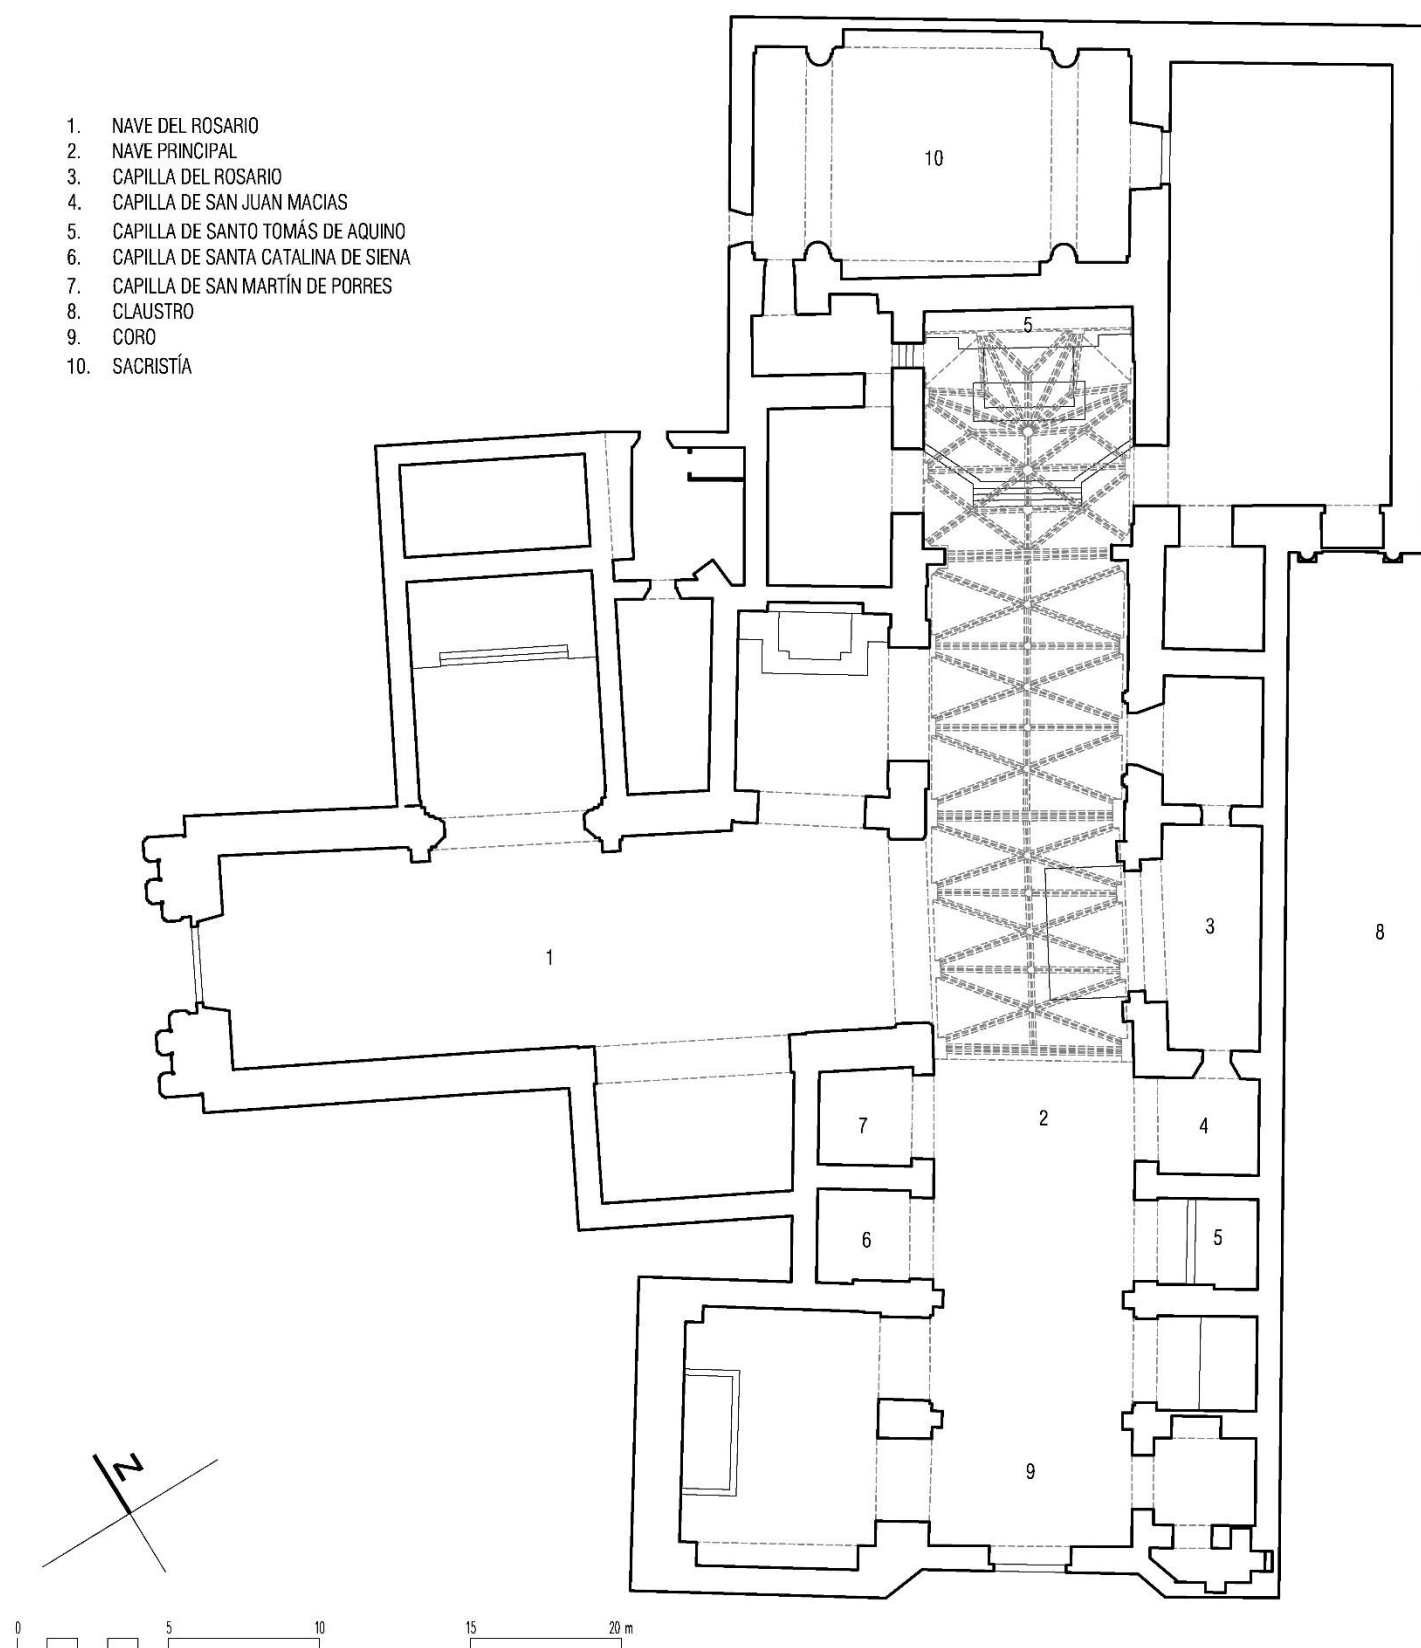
Planta general de la iglesia. Convento de Santo Domingo. Jerez (Planimetría de Manuel Collado Moreno).
